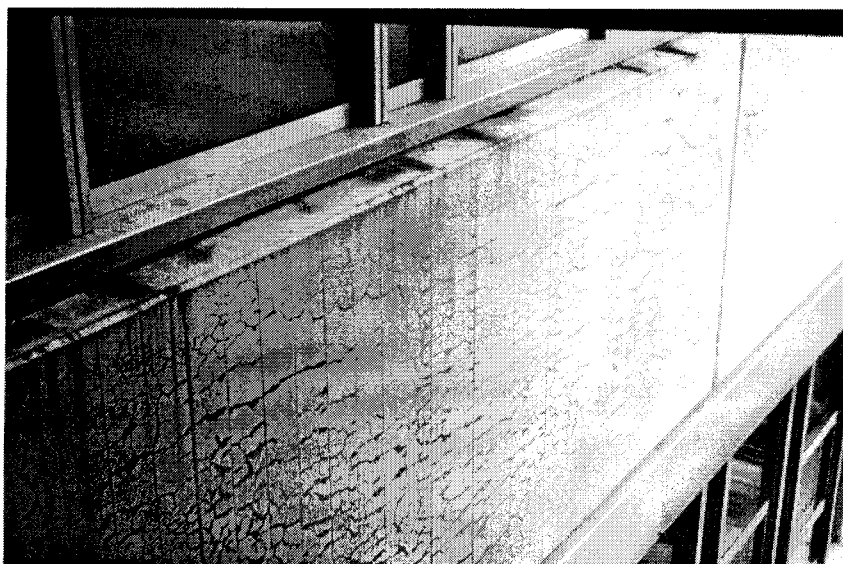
Eigenspannungsrissbildung in einem Leichtbetonfassadenelement.
